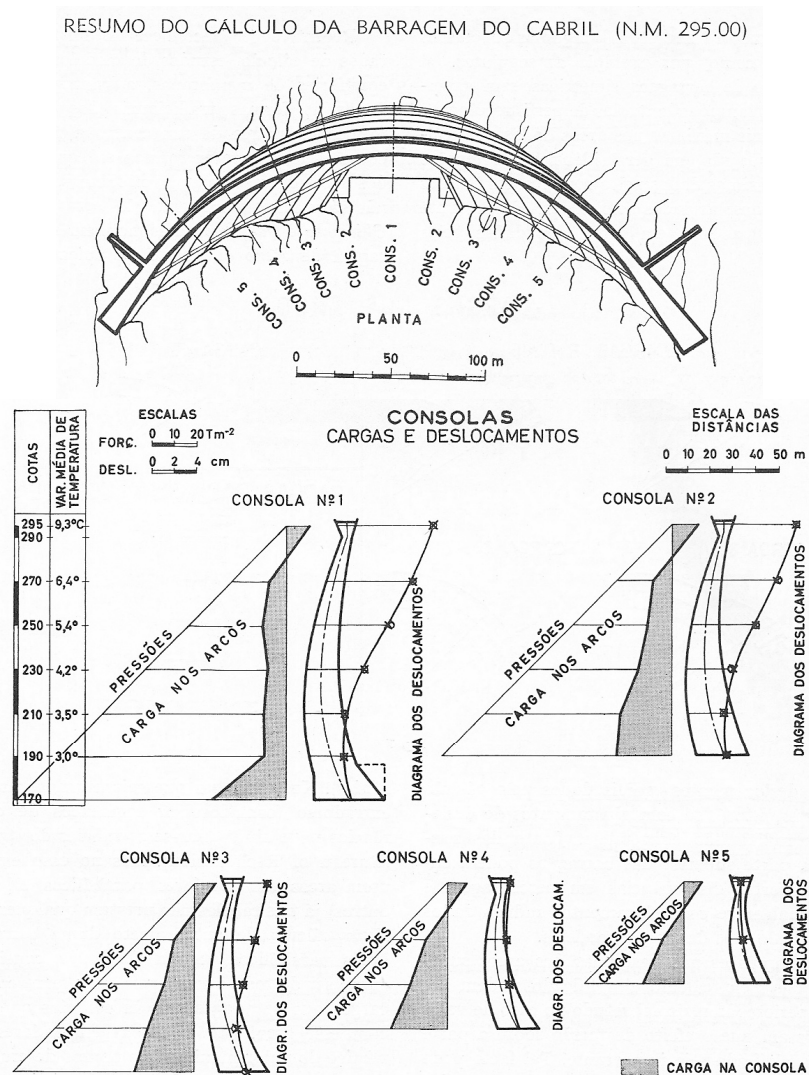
Distribuição da pressão hidrostática pelos arcos horizontais e consolas verticais, radiais, da barragem do Cabril, com indicação das deformadas das consolas [34].
